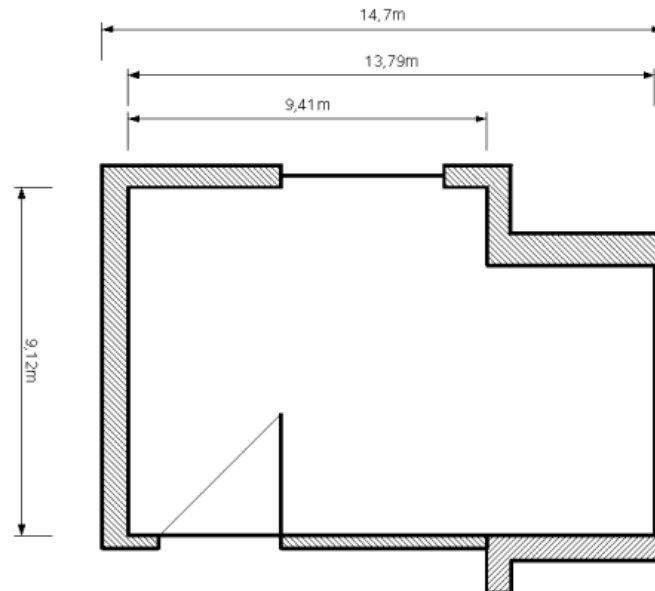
Grundrisszeichnung eines Zimmers
